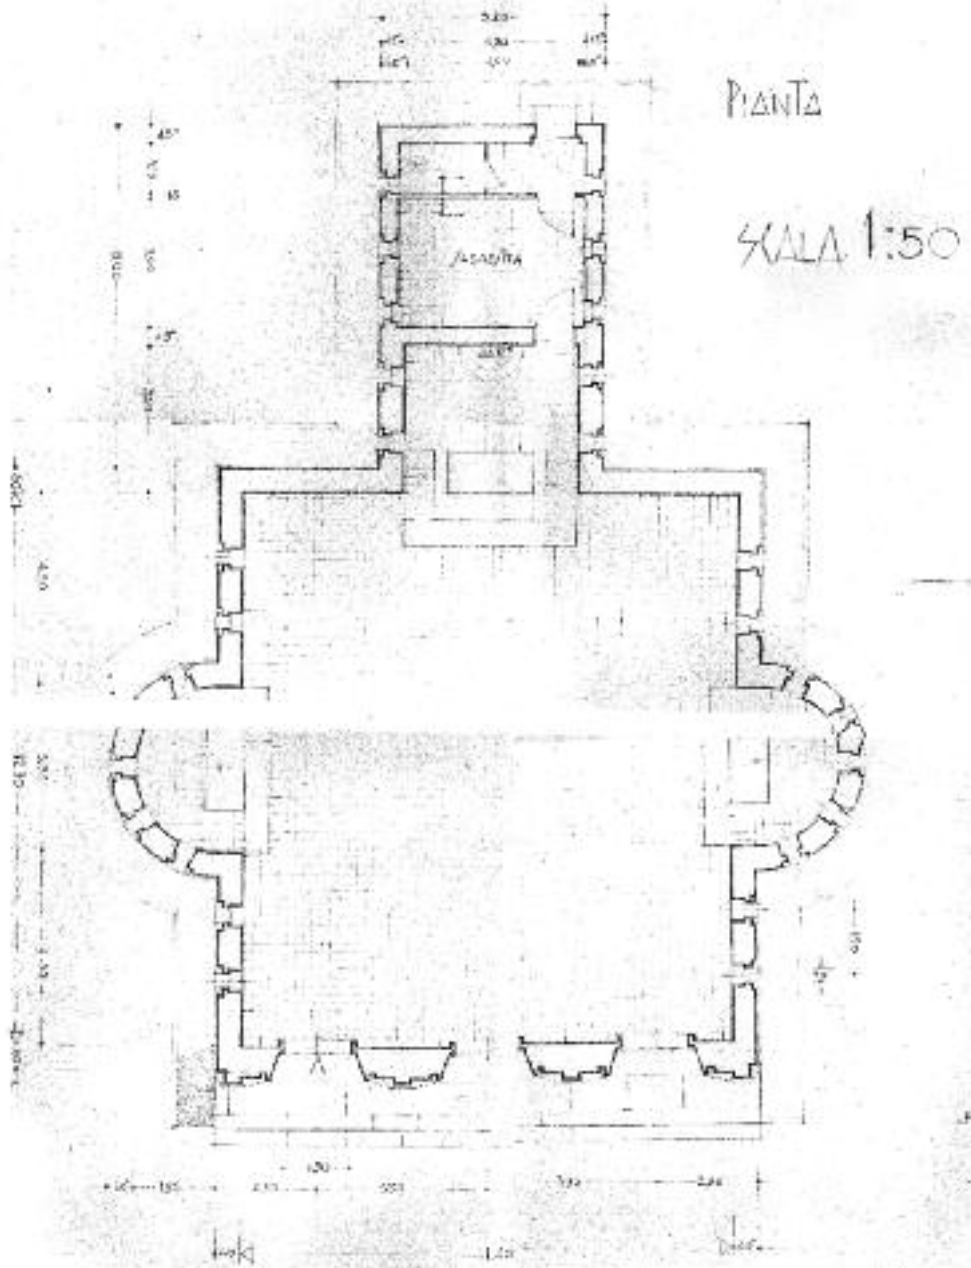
/24 - Pianta e prospetti del primo progetto per la chiesa di "Metaurilia"
